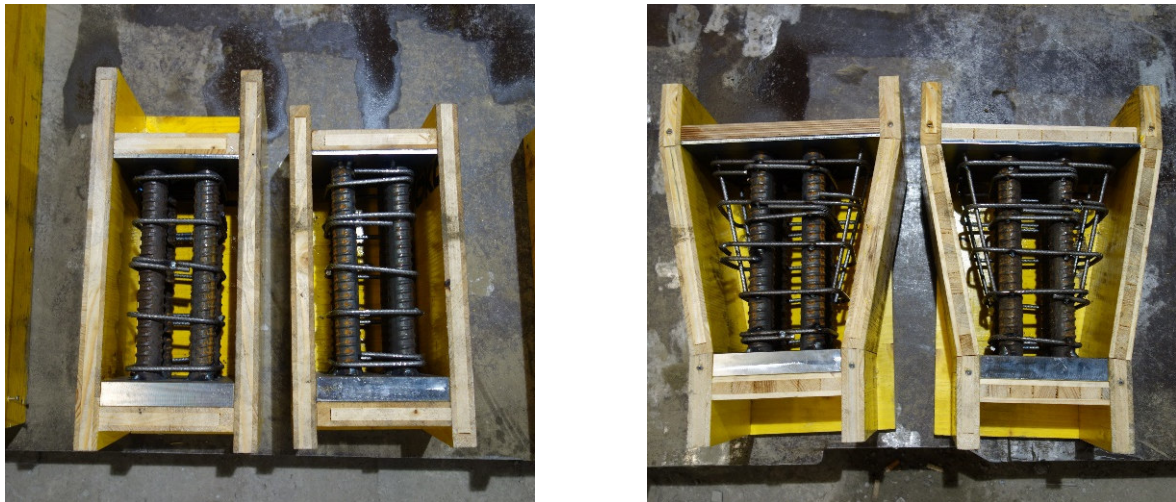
Bewehrungslage a) Stumpfstoß, b) Stumpfstoß mit Aufweitung
